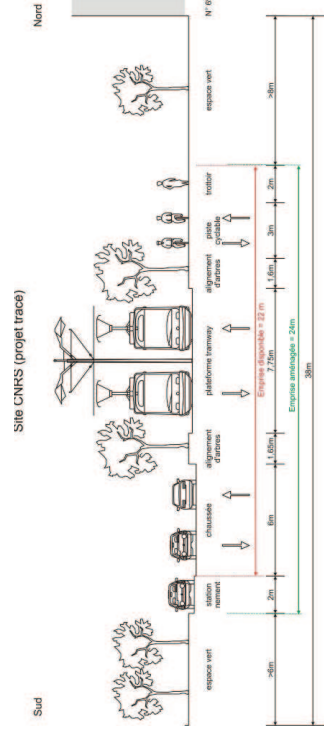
situation projetée. Coupe sur le site du CNRS (Variante1).
